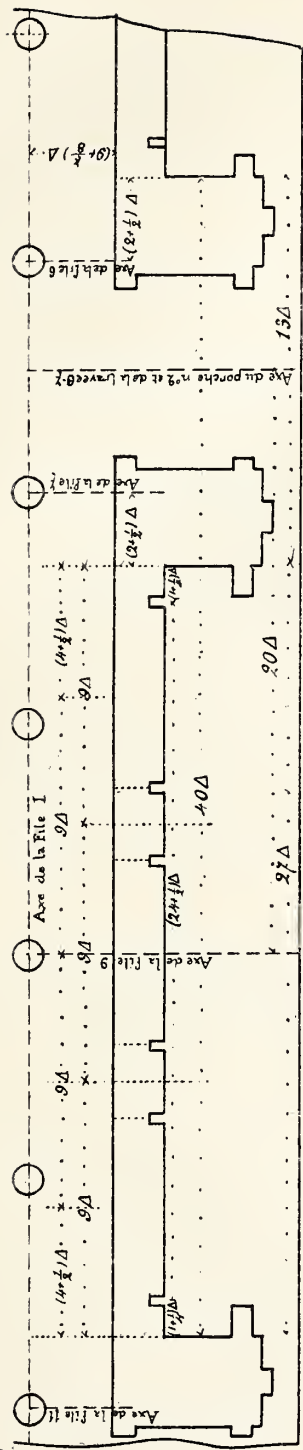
Coupe horizontale du mur de clôture à la hauteur des prises des contre-fiches.
